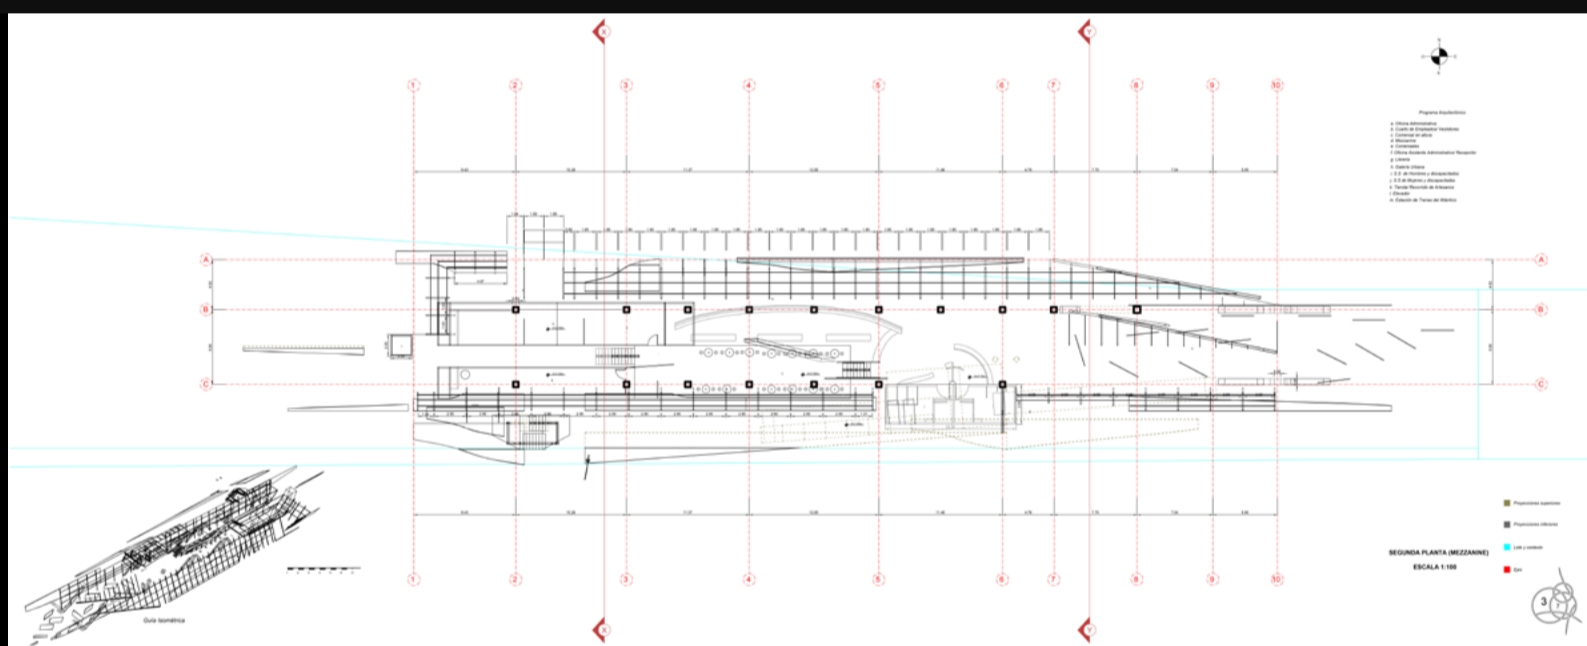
Planta arquitectónica segundo nivel-mezzanine
